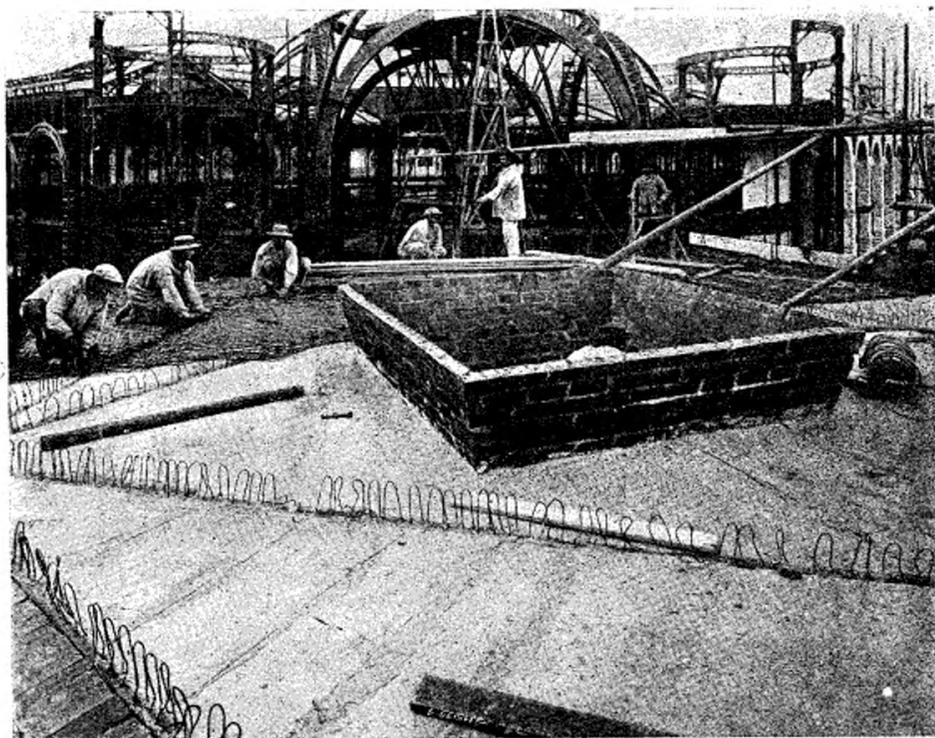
Vue photographique de la terrasse-couverture du Pavillon de San-Marin.
